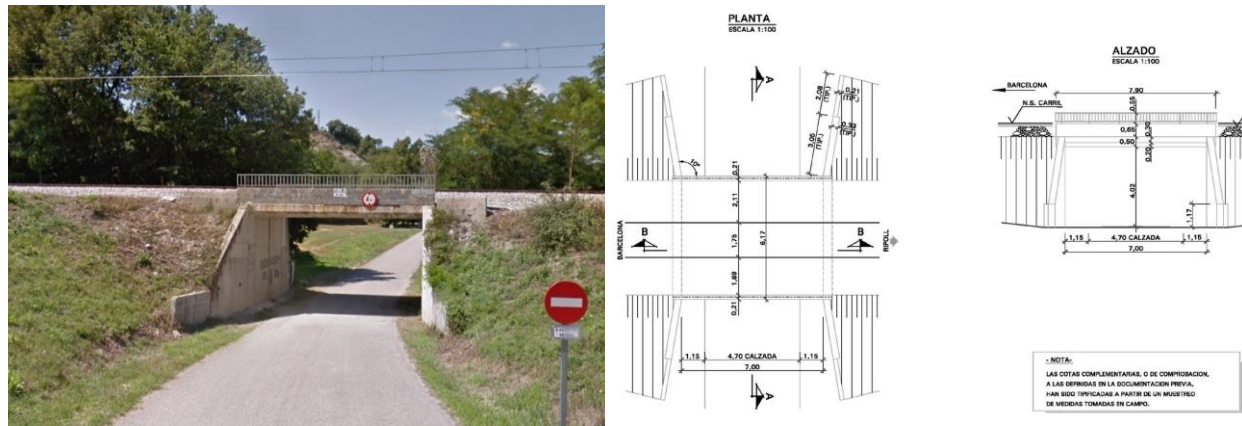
Paso inferior existente en carretera local en el P.K. 59+230. Para la duplicación se contempla el ensanche de la estructura.
